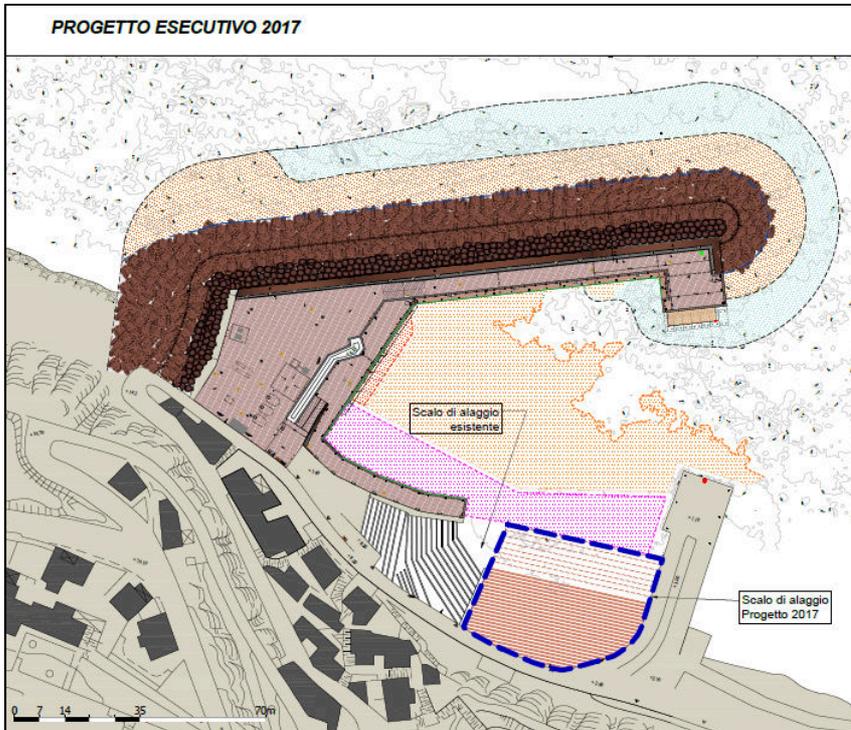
Planimetria generale del progetto del 2017, con indicazione dello scalo di alaggio
